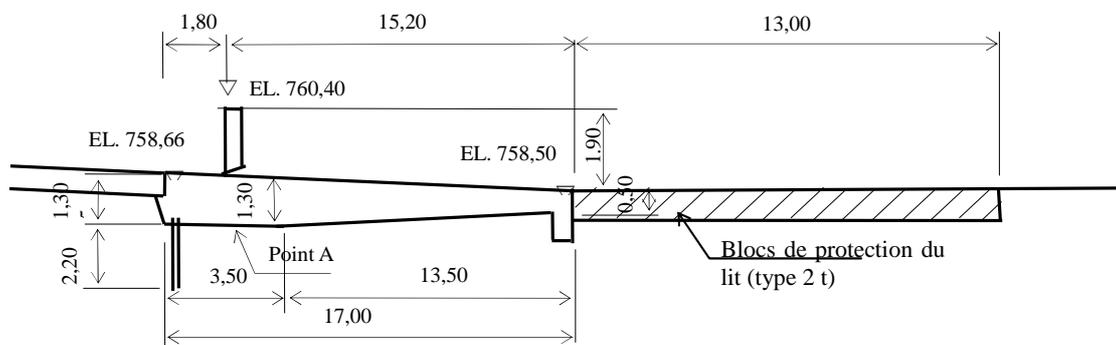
Plan en coupe standard du radier de déversoir
